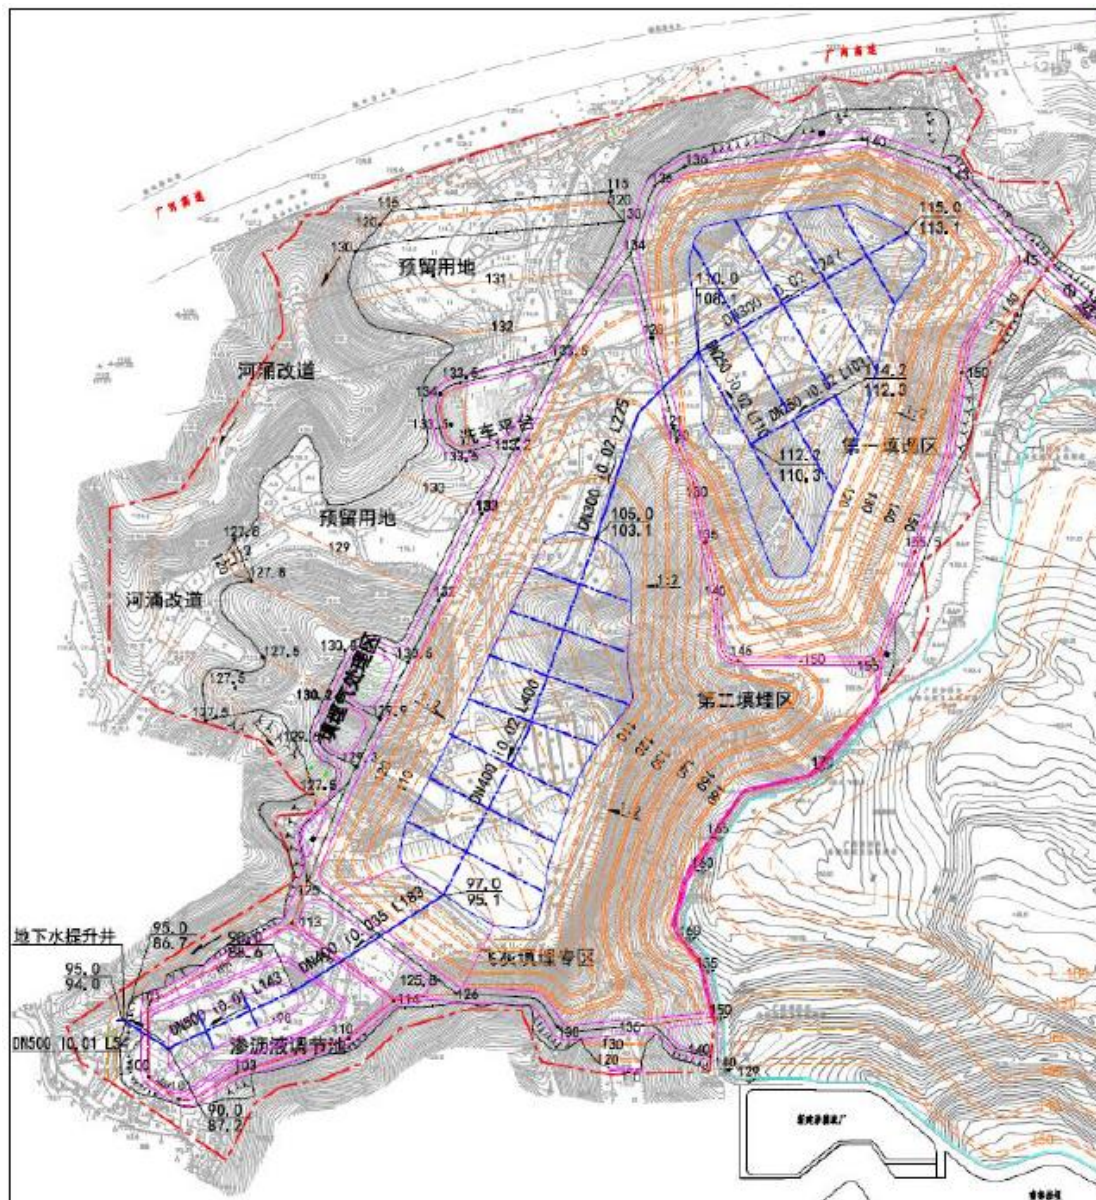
第二填埋区建设地下水收集和导排系统平面图
